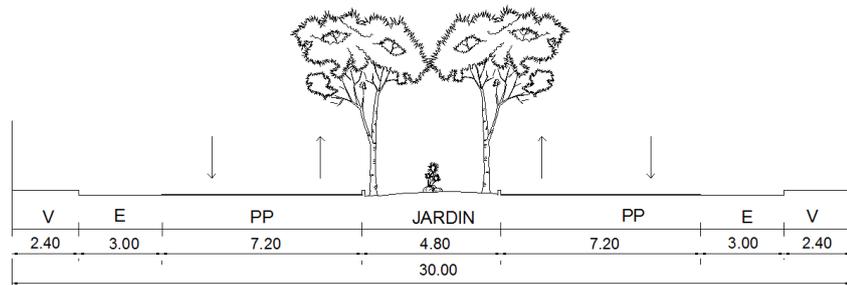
Sección de la avenida Sldo. Estanislao Córdor que colinda con el terreno del proyecto.
